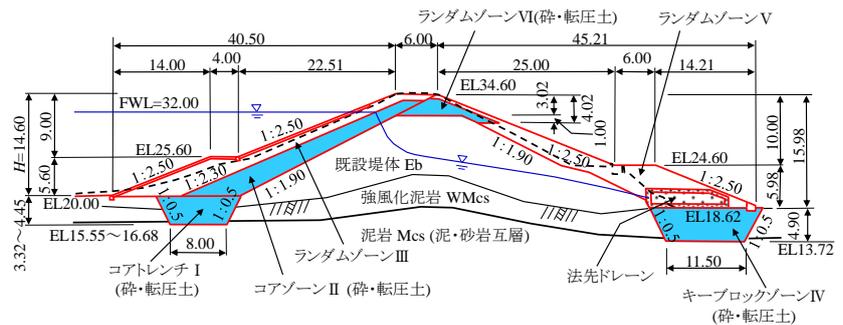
谷田大池の改修後堤体の標準断面<sup>10)</sup>
